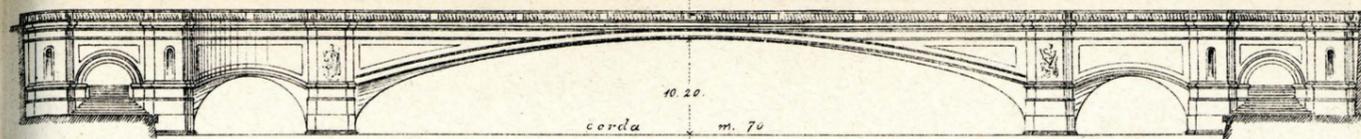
Progetto di ponte in muratura dell'Ing. Ferria.
